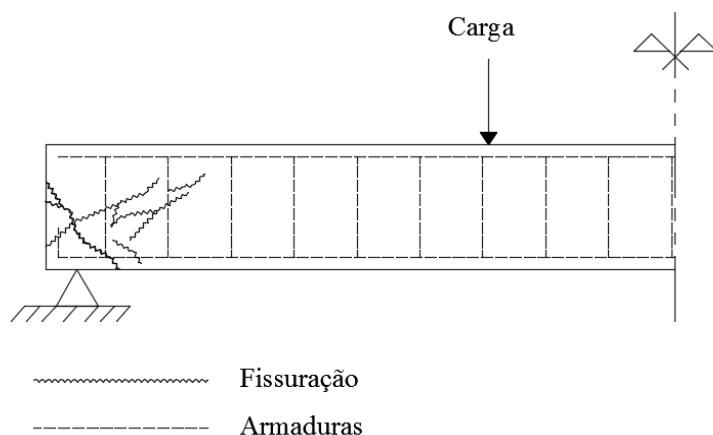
Rotura por esmagamento da biela de compressão (adaptado de Barros, 2009)
